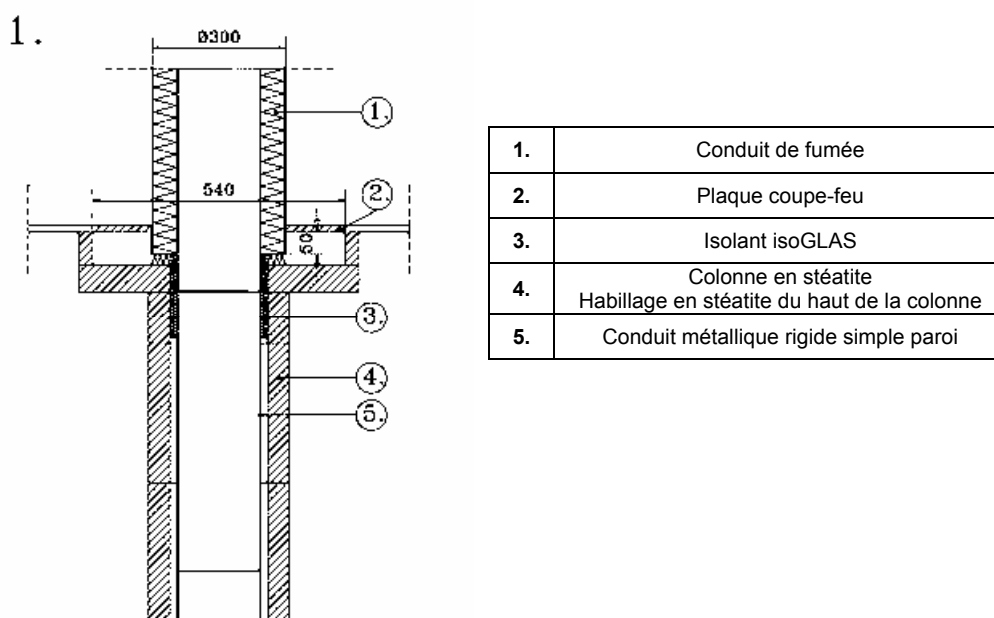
Jonction colonne en stéatite et conduit de fumée en attente au plafond
